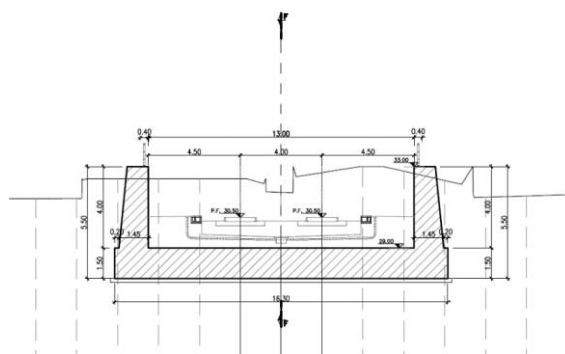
Sezione muro di imbocco (Hmin=4.00 m)
